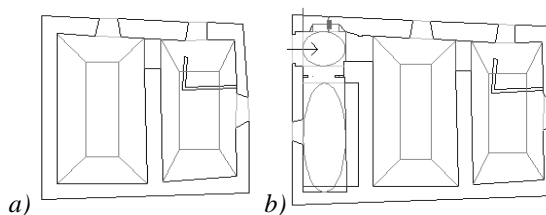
Pianta piano terra dell'edificio oggetto di studio: a) Fase evolutiva n.1; b) Fase evolutiva n.2.
